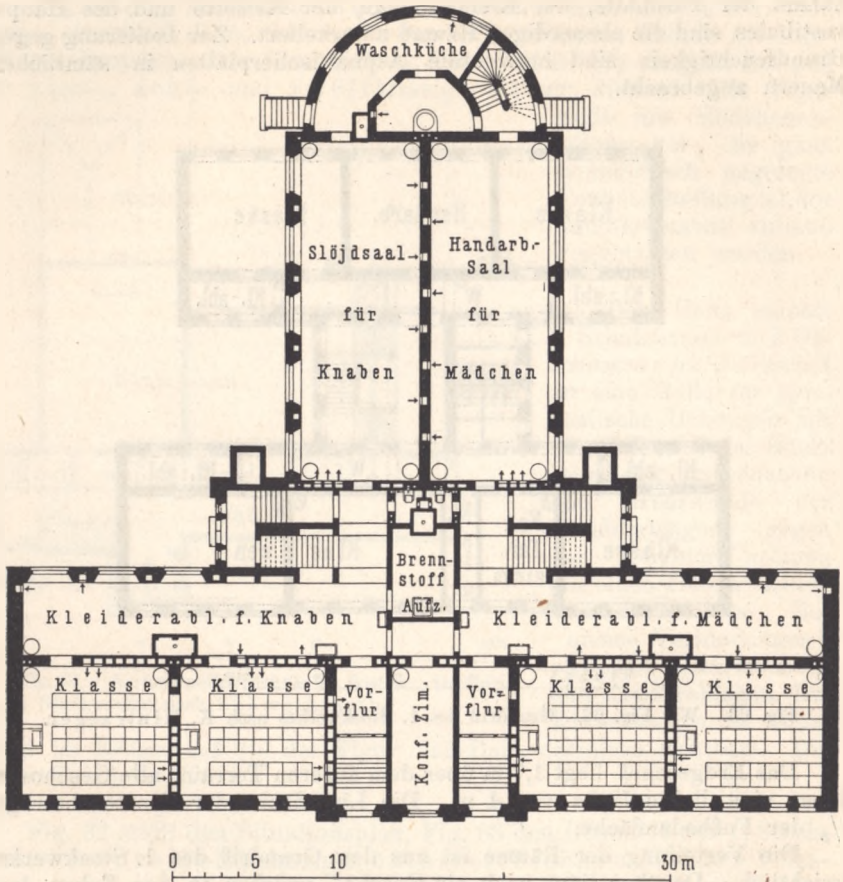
Grundriß des Erdgeschosses der vierzehnklassigen Volksschule zu Wiborg, Finnland, nach Sjöström aus Hintraeger⁸⁵.
